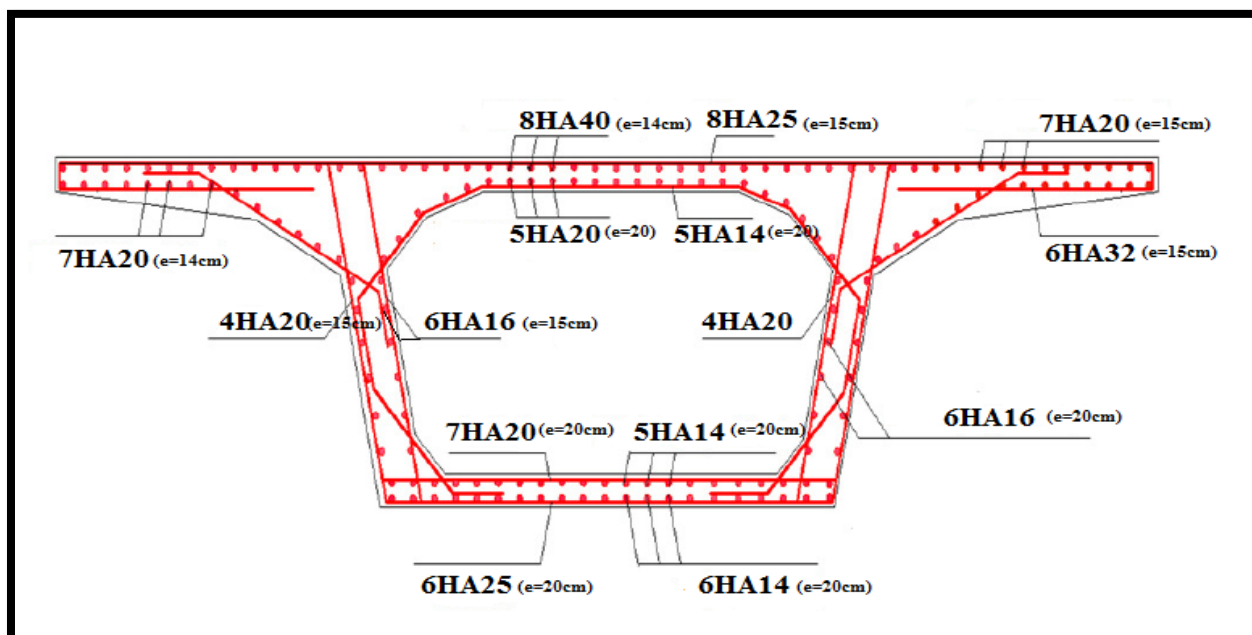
Schéma de ferrailage du voussoir au clavage
